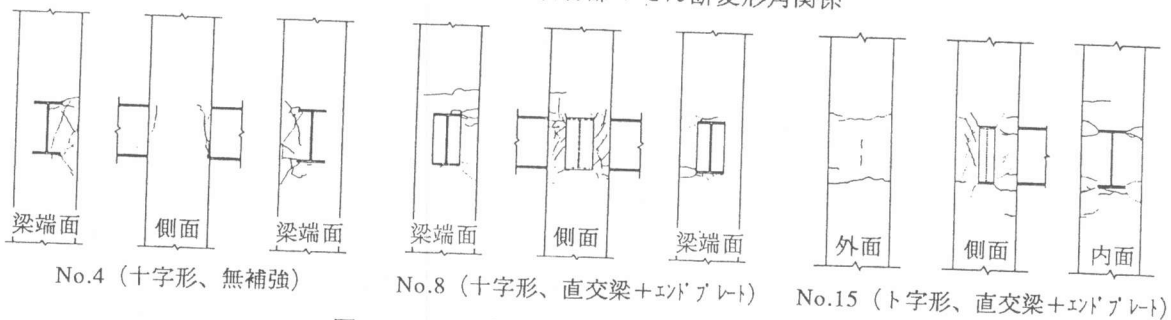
ひび割れ状況 (R =  $\pm 1/100$ 終了時)
